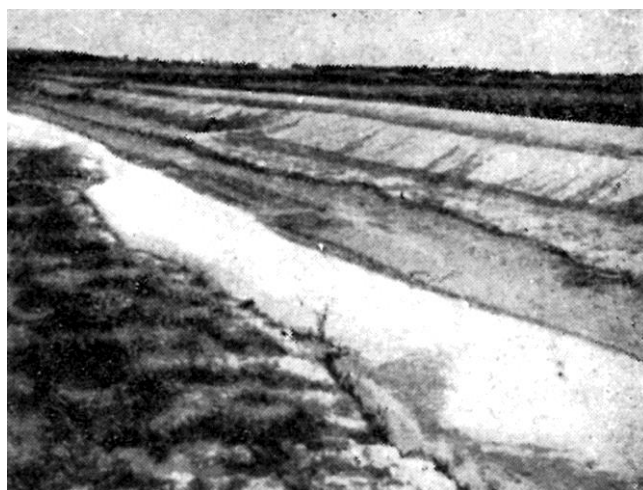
Canalul Dâmbovița înainte de finisarea taluzurilor
